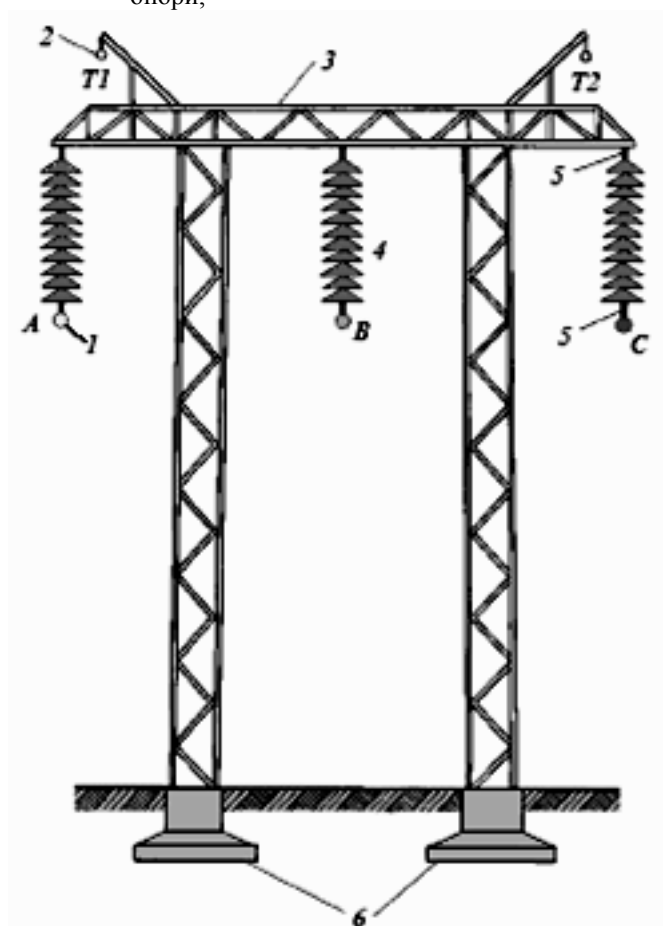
Конструктивні елементи ПЛ: 1 – проводи фаз ліній (А, В, С); 2 – захисні троси (Т1, Т2); 3 – опора; 4 – гірлянда ізоляторів; 5 – елементи арматури; 6 фундаменти.
